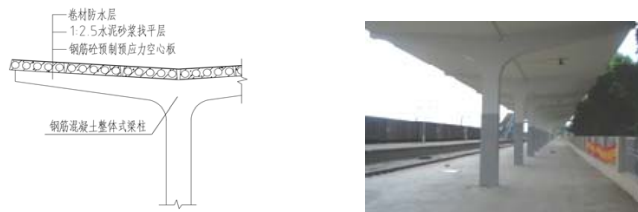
预制装配式钢筋砼板雨棚屋面示意图 图2 原玉林站站台雨棚特点分析:此类型屋面的优点是建造速度快,受气候条件制约小,节约劳动力。其结构体系受列车进出站震动影响,板端头易出现移位,且加固措施工艺烦琐,维修施工难度大。目前有预制装配式钢筋砼板屋面的客站台雨棚现已陆续拆除重建。
